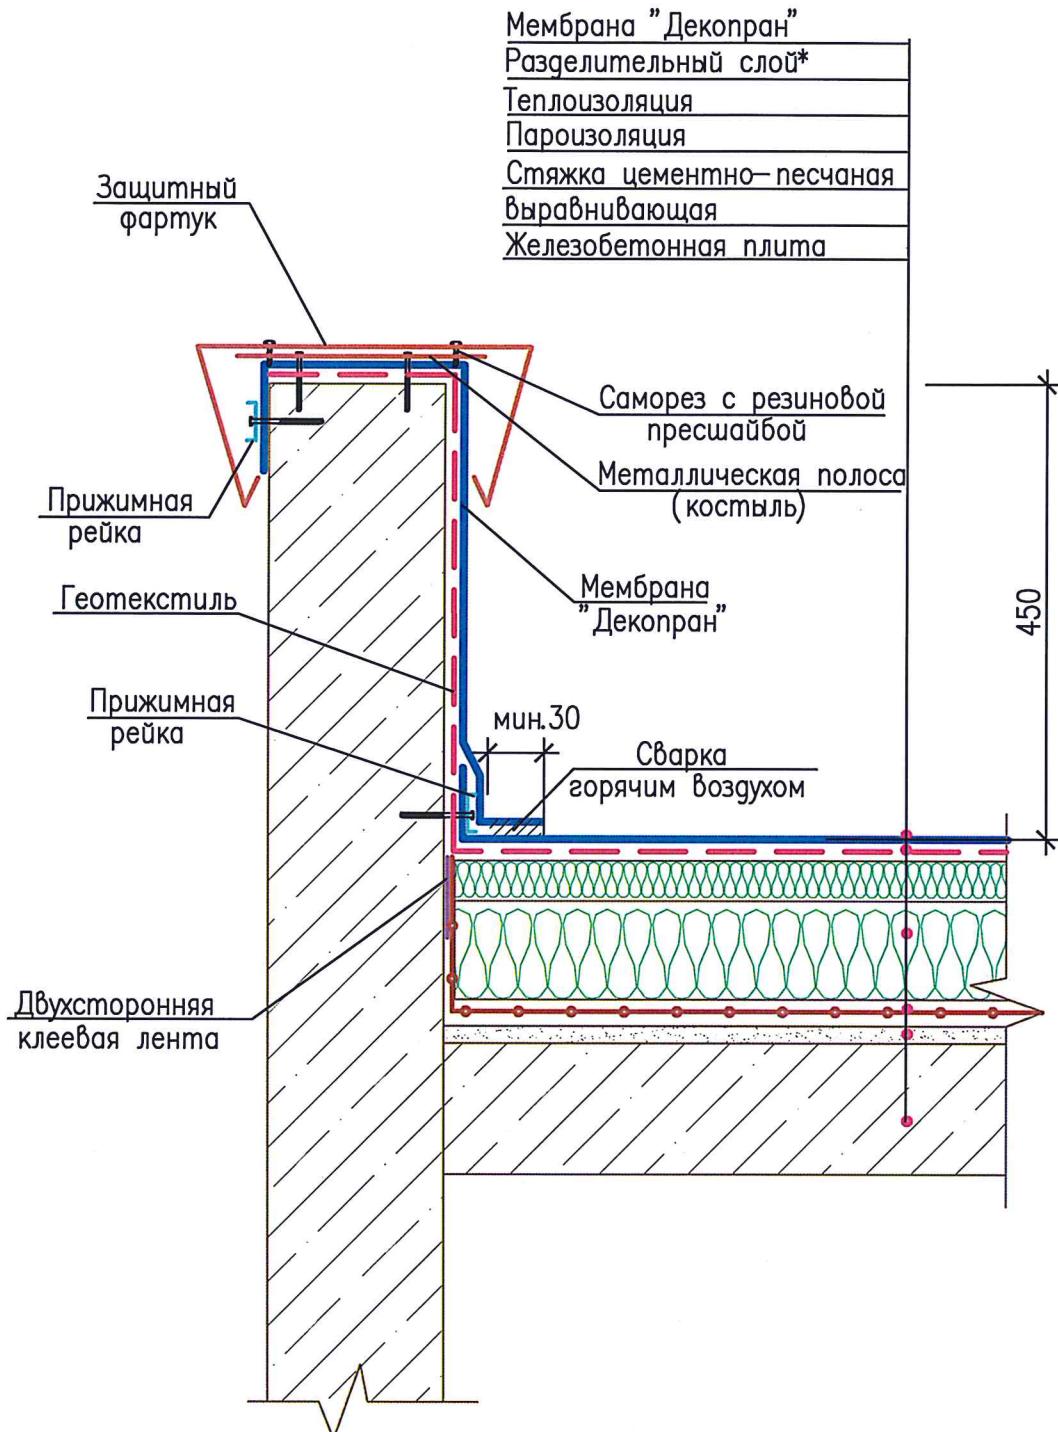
Механическое закрепление к железобетонному основанию. Обработка внешних и внутренних углов
